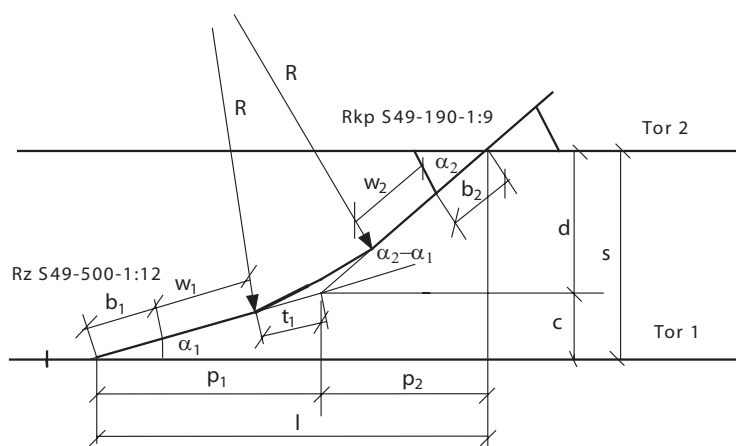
Fragment planu sytuacyjnego stacji z zaznaczonym układem
